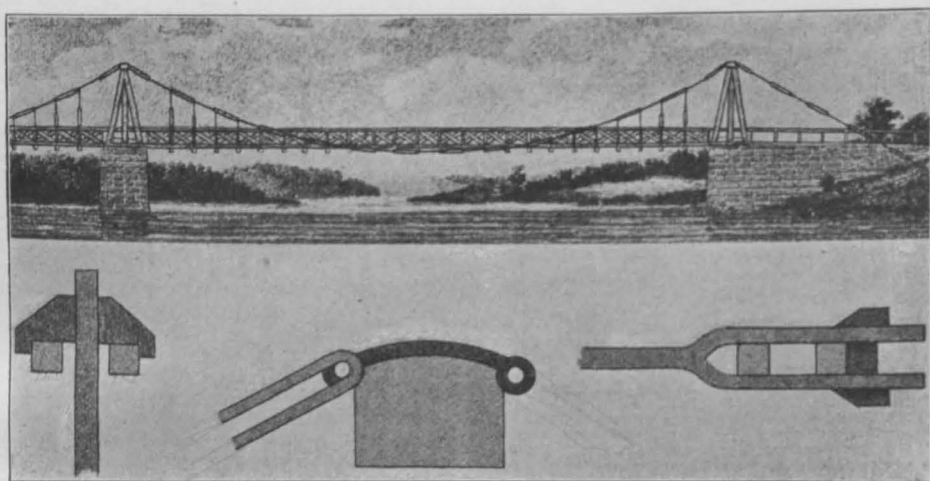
Bauart einer Kettenbrücke nach JOHN FINLEY. 1801—1808.
